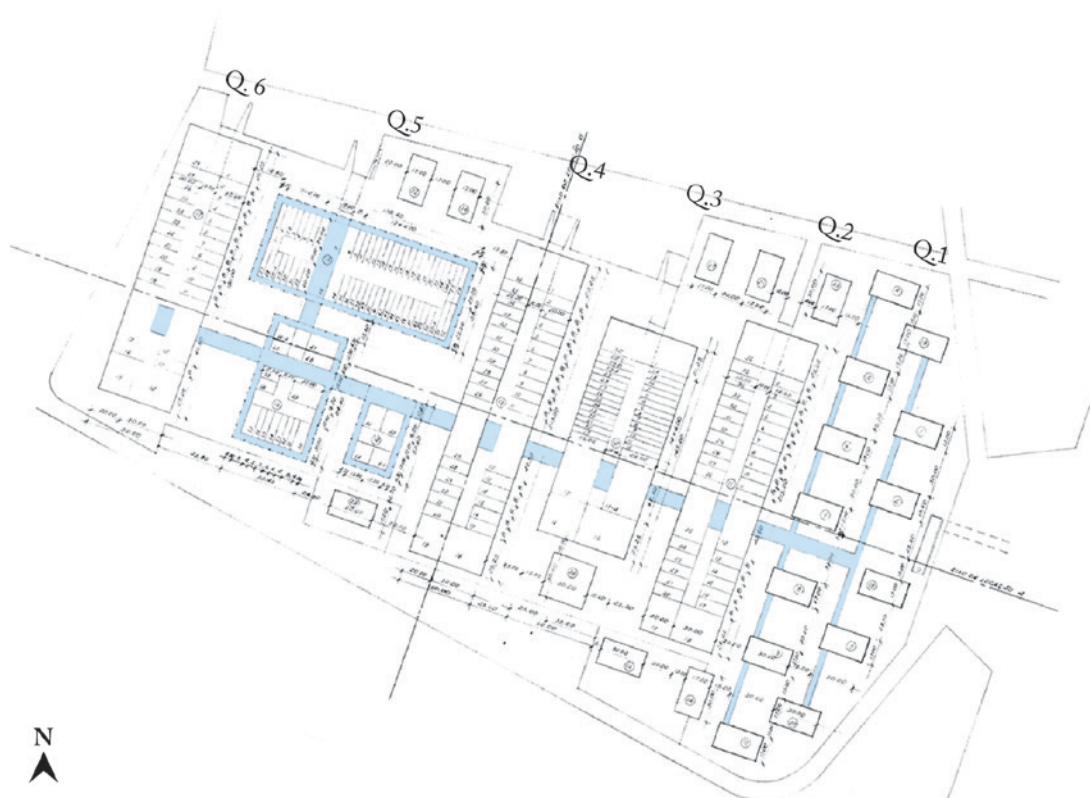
Planta de Pavimento-tipo com as marquises destacadas em azul.
